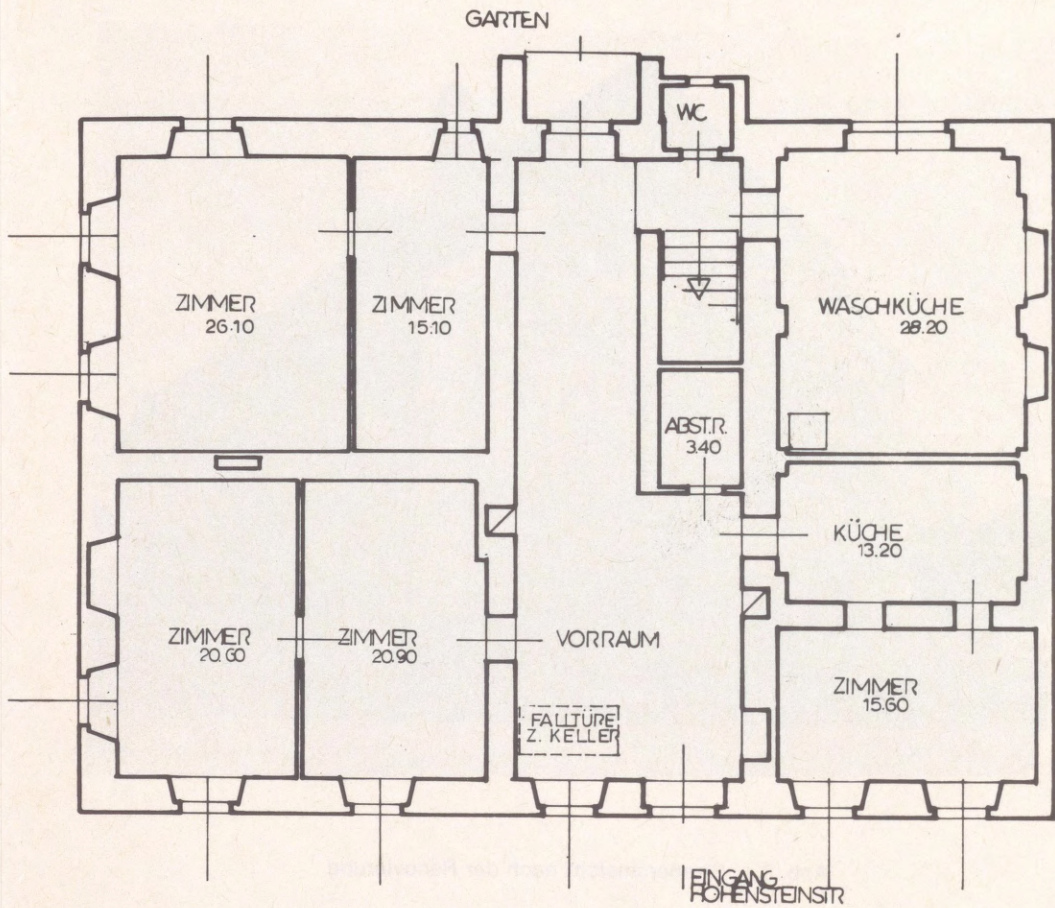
Plangestaltung des Erdgeschosses vor dem Umbau
